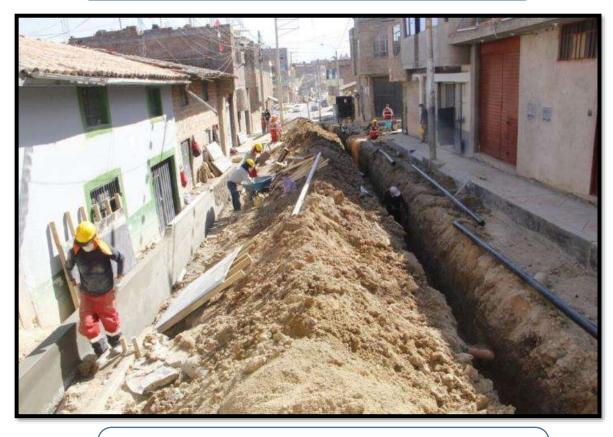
en la imagen se visualiza los trabajos previos a la pavimentación de la Av. Los Héroes, el cual es el cambio de tubería por diversos motivos.
